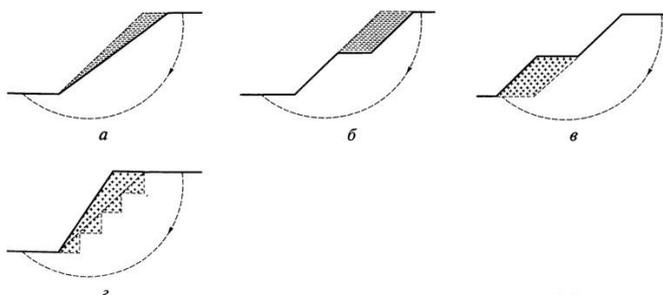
Способы повышения устойчивости откосов путем срезки и насыпи грунта:
